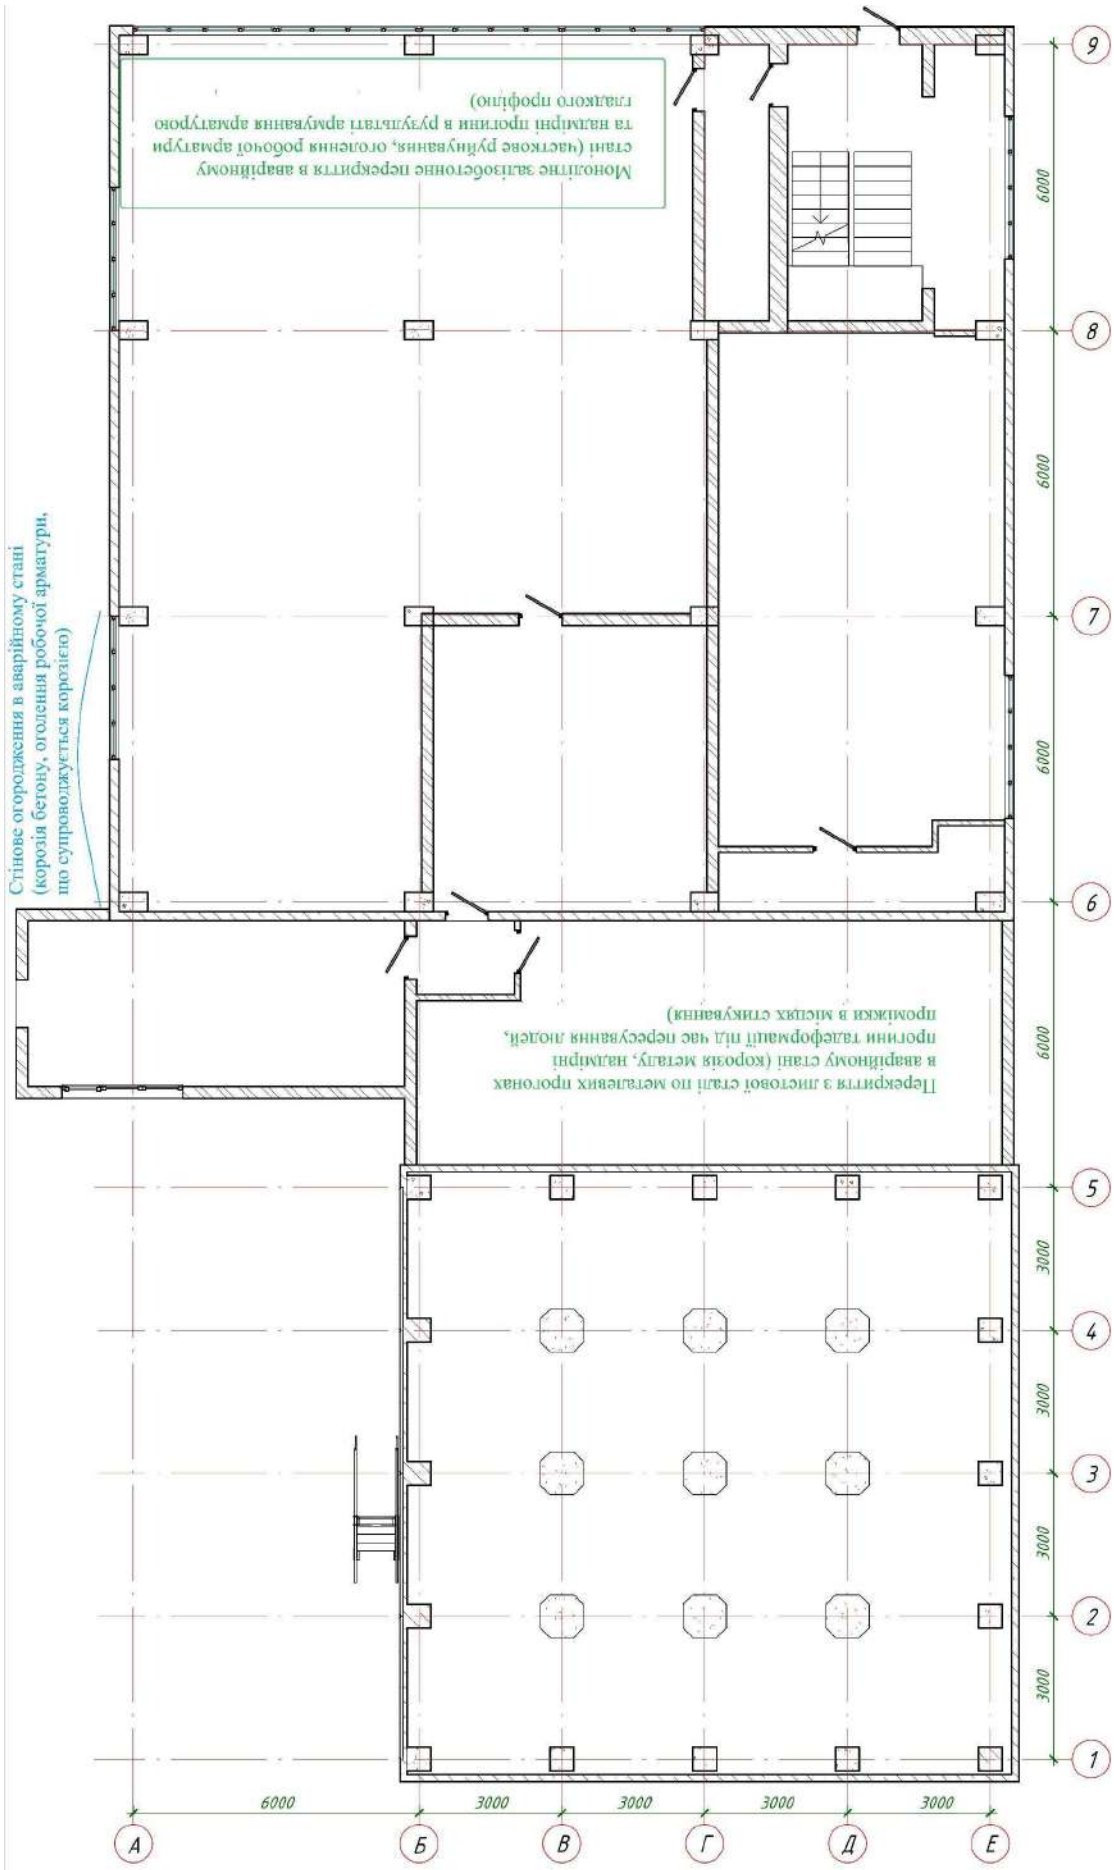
Схема виявлених дефектів, що впливають на подальшу надійну та безпечну експлуатації будівлі
